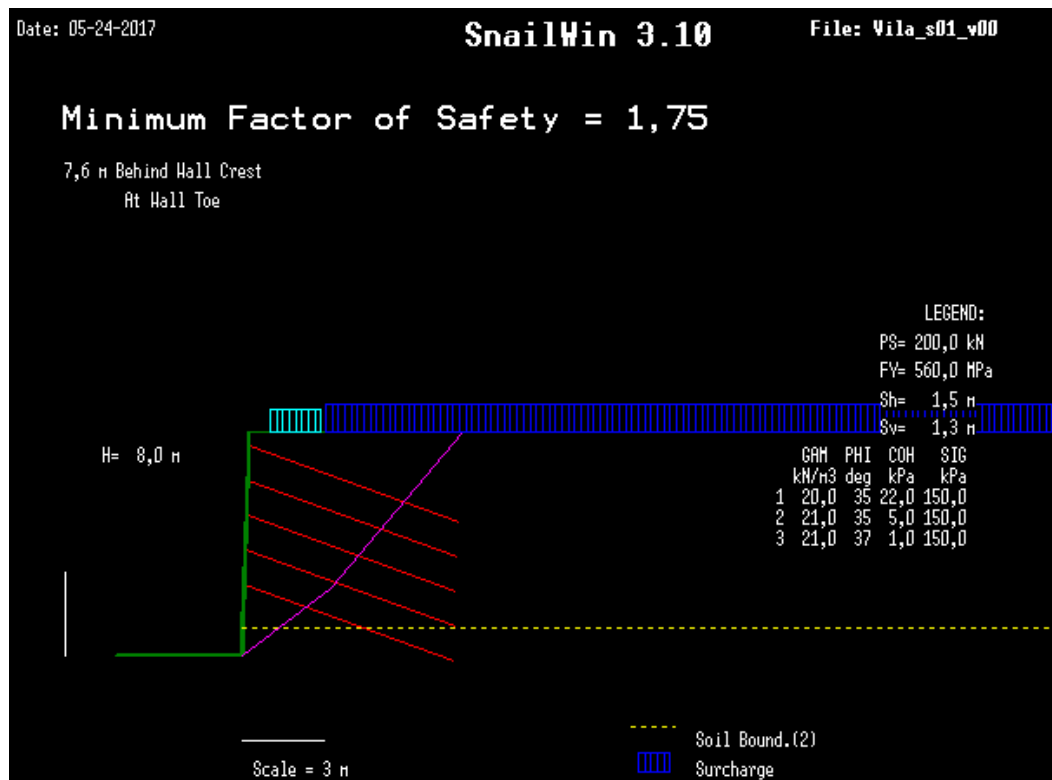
Sección 3 de cálculo con el software SNAILZ.
